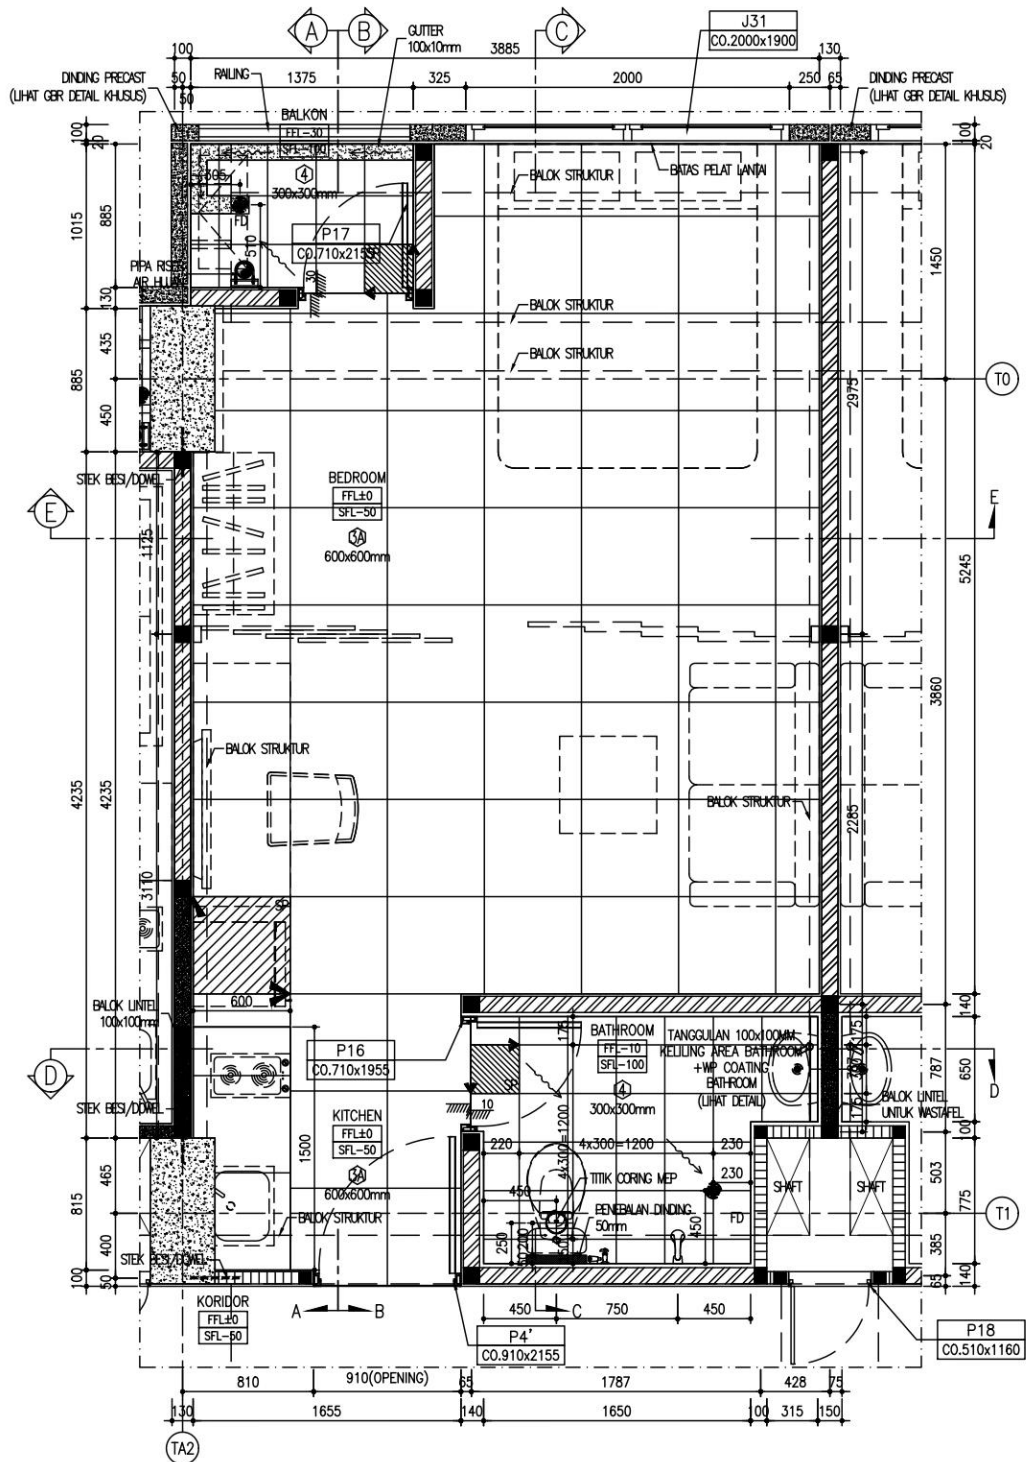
24 Denah pola lantai unit 1BR-C
